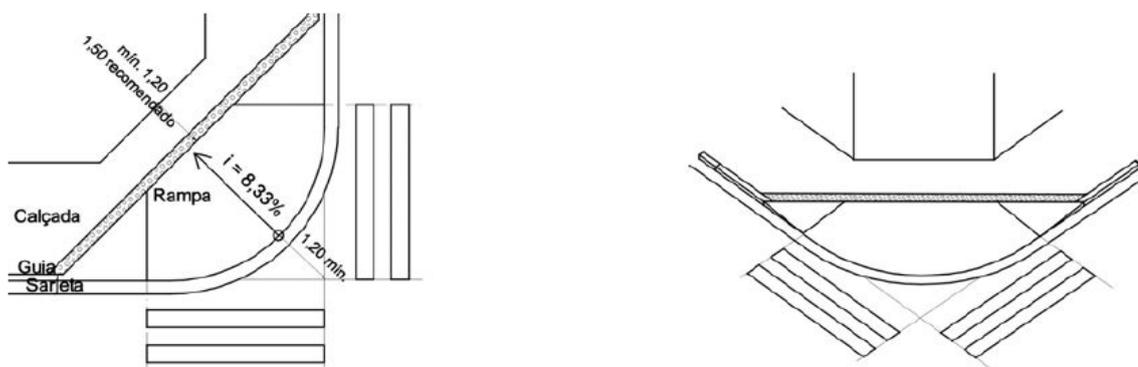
Tipo 2 de rebaixamento da calçada - esquinas.
